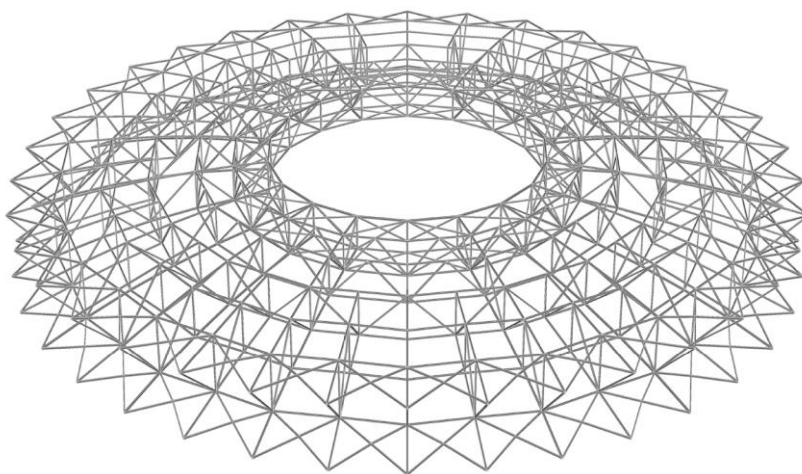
Расчетная схема куполовидной радиальной фермы
